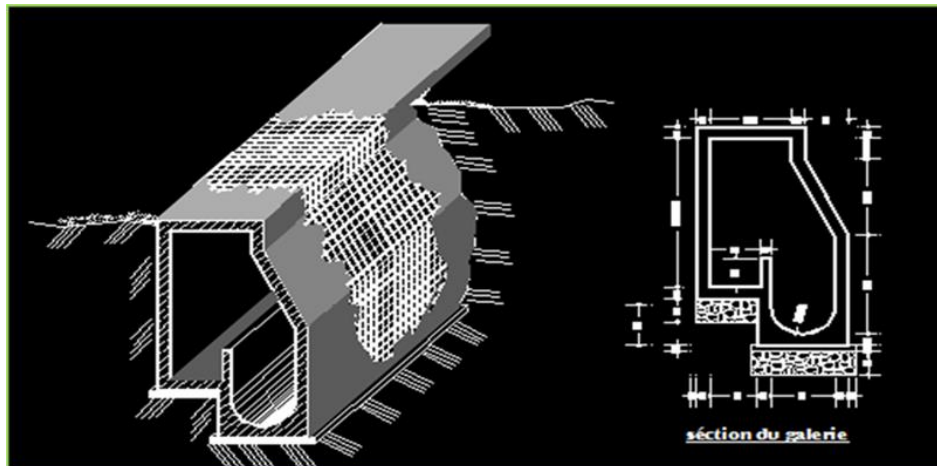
Schéma 3D avec la section transversale de la galerie
